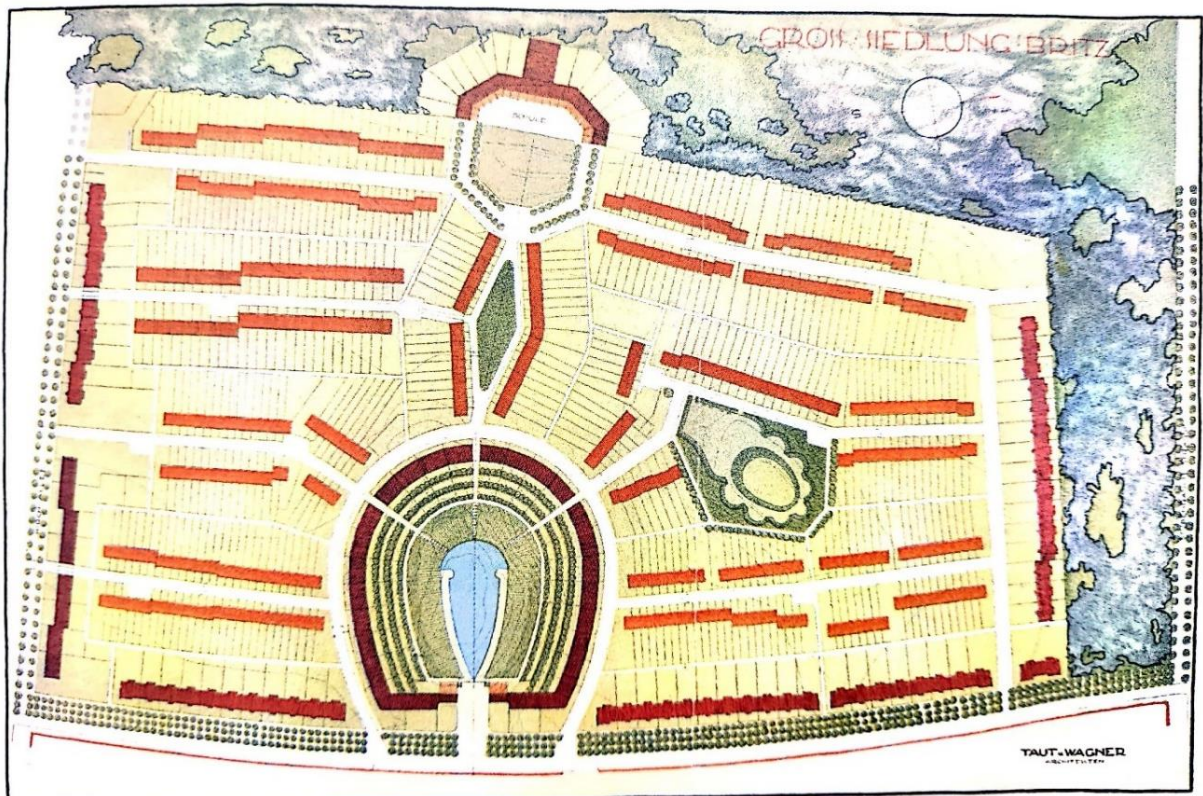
Planta da Hufeisensiedlung. Fonte: Akademie der Künste, Coleção Bruno Taut, n. 0102-002 (ARCHITEKTEN et al., 2020).
